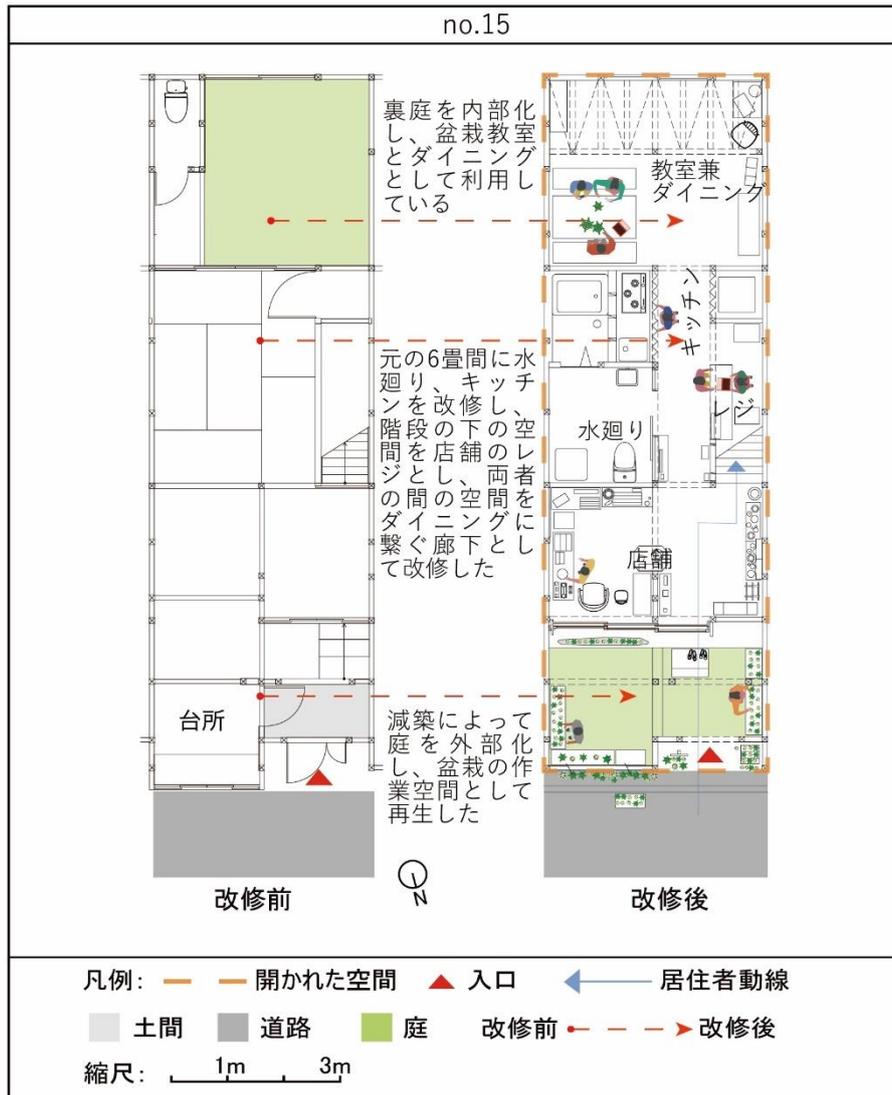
事例 no. 15 の改修前後の平面配置図
